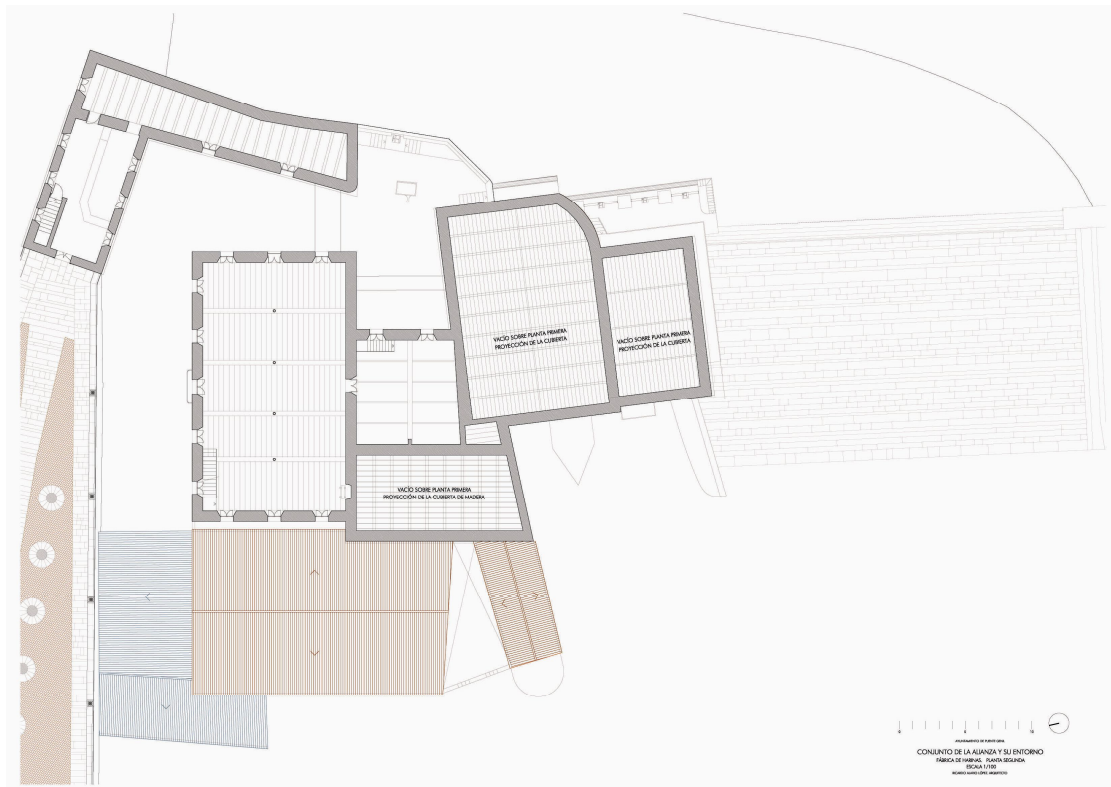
Conjunto de La Alianza y su entorno. Planta segunda. Escala 1/100. Fuente: Ricardo Alario López (arquitecto).
